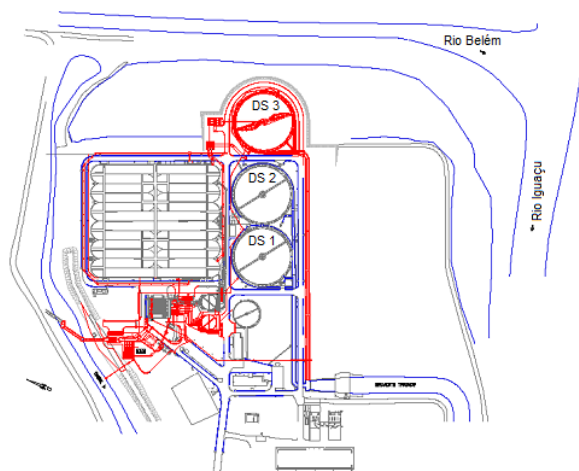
Planta genérica da área da ETE Belém (sem escala).
